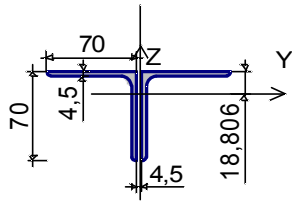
Сечение нижнего пояса по первой схеме загрузки
